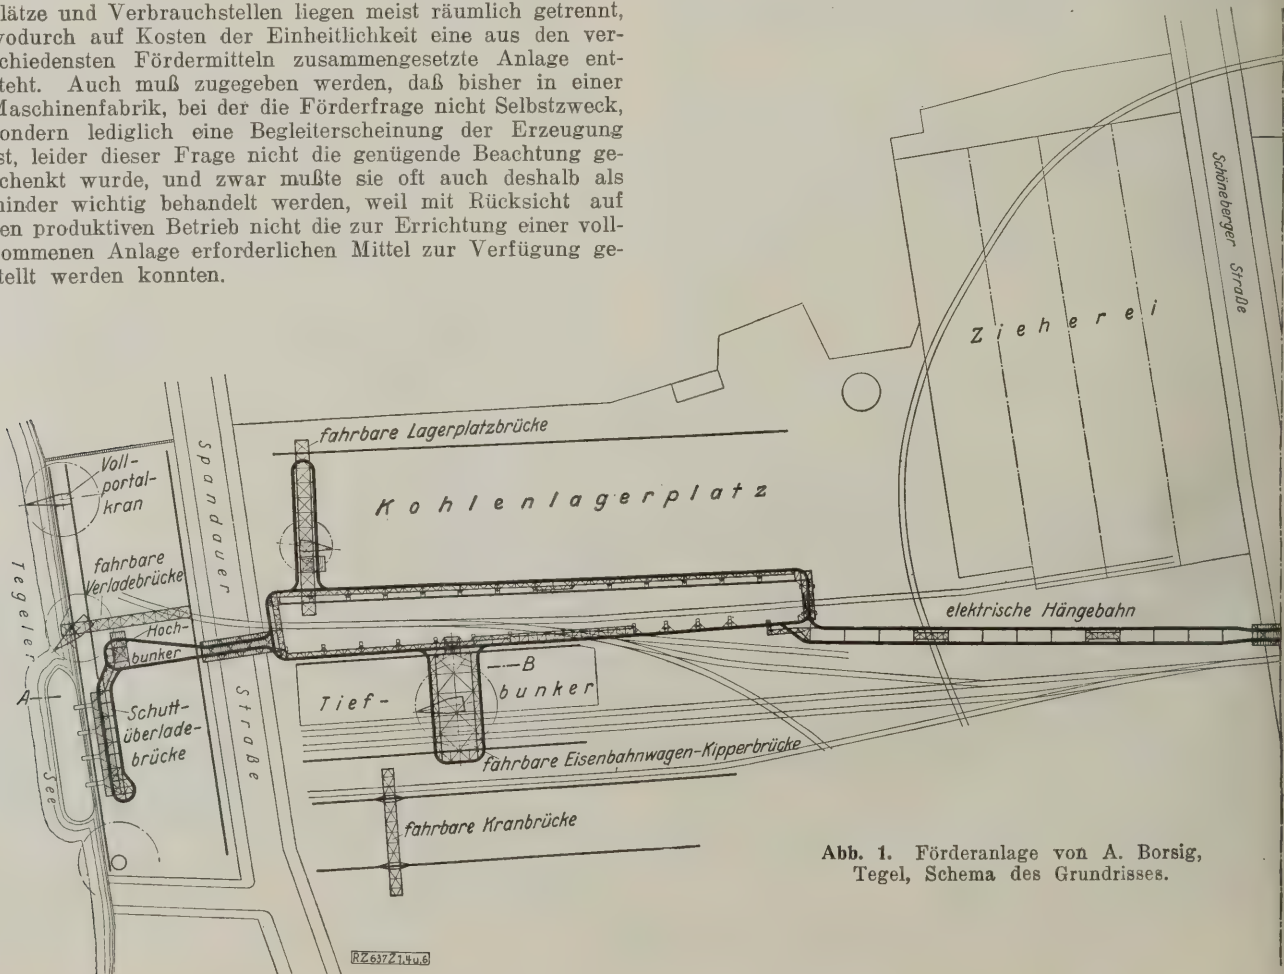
Förderanlage von A. Borsig, Tegel, Schema des Grundrisses.
